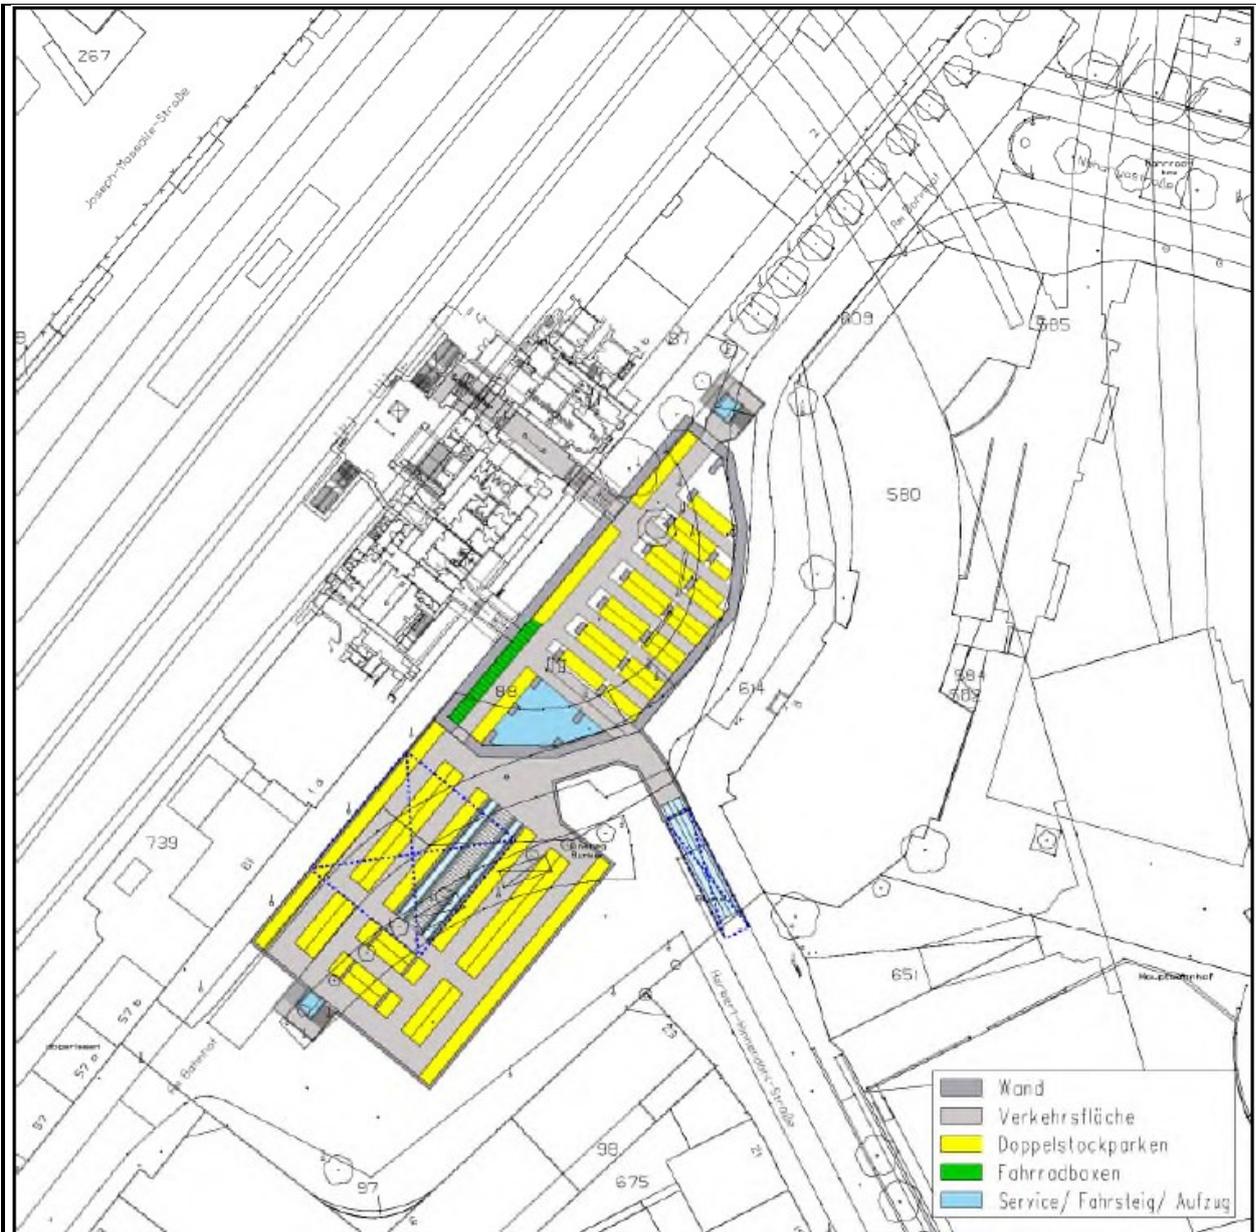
Planungsvariante 4 - Bunker mit vergrößerter südwestlicher Erweiterung
